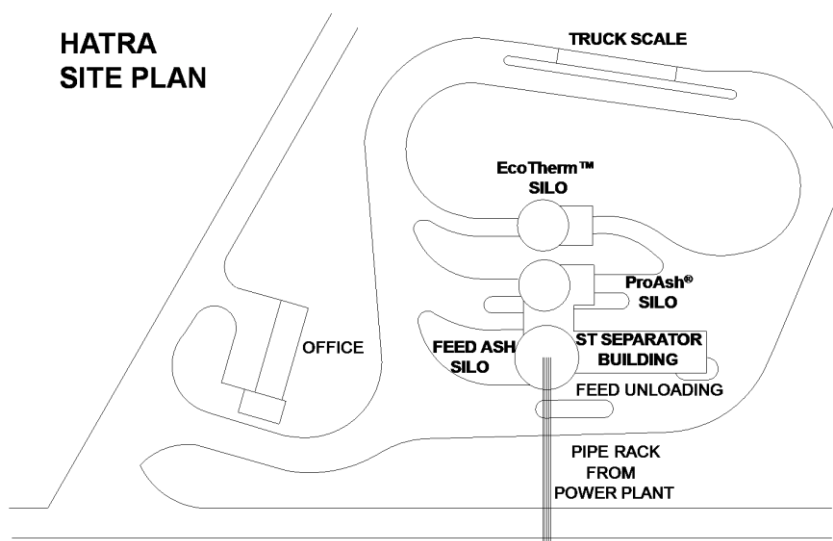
Ситуационный план ТЭС Hatra: Office – офис; Truck Scale – весовая; EcoTherm™ Silo – силос EcoTherm™; ProAsh® Silo – силос ProAsh®; Feed Ash Silo – силос исходной золы; ST Separator Building – помещение сепаратора ST; Feed Unloading – приемный узел исходной золы; Pipe Rack From Power Plant – трубная эстакада от ТЭС.
